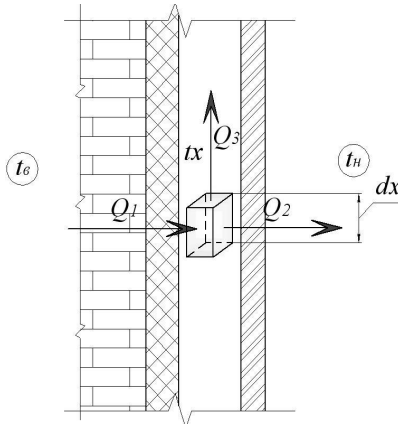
Расчетная схема распределения теплового потока в конструкции с вентилируемой прослойкой (согласно [1])
